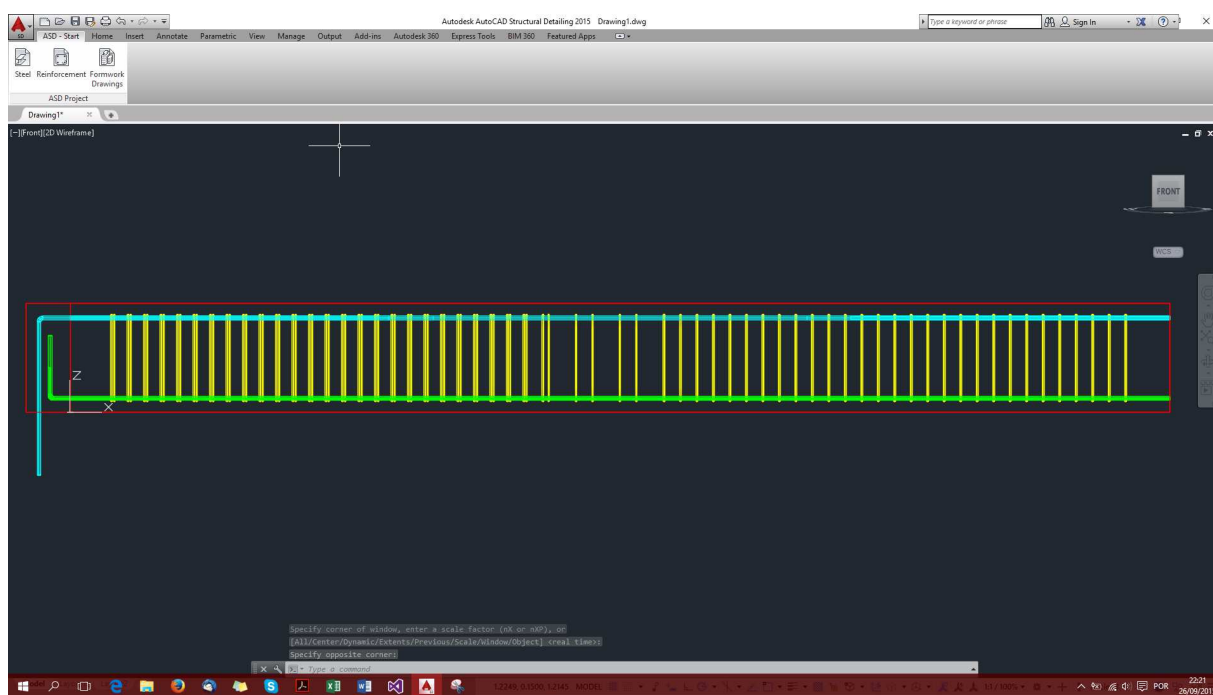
Pormenorização de uma viga recorrendo ao addin (vista em alçado).
